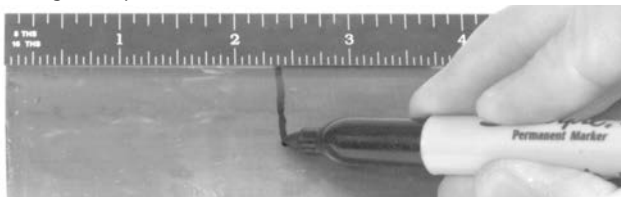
A – Inspección del acoplamiento ProPress de acuerdo a las instrucciones de su fabricante
